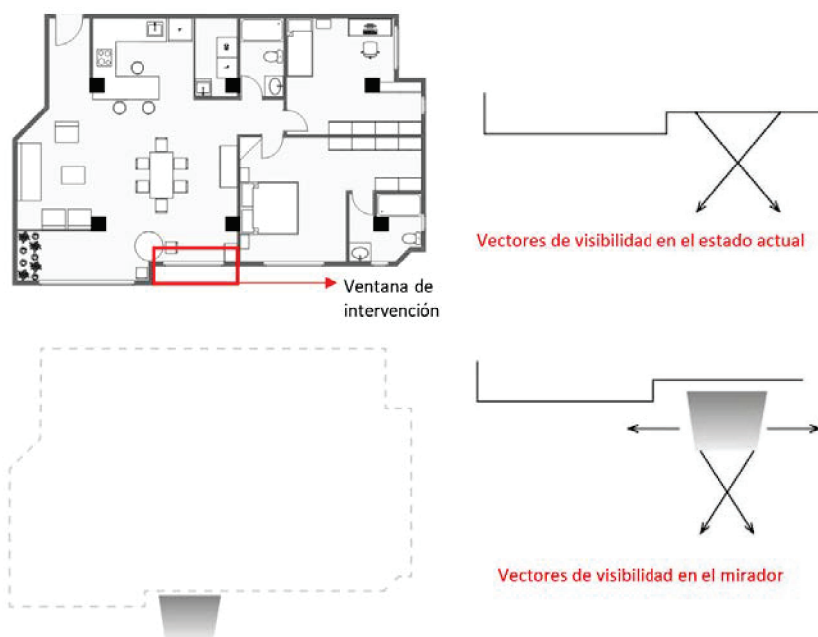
Esquema de planta final de la intervención. Elaboración: propia
